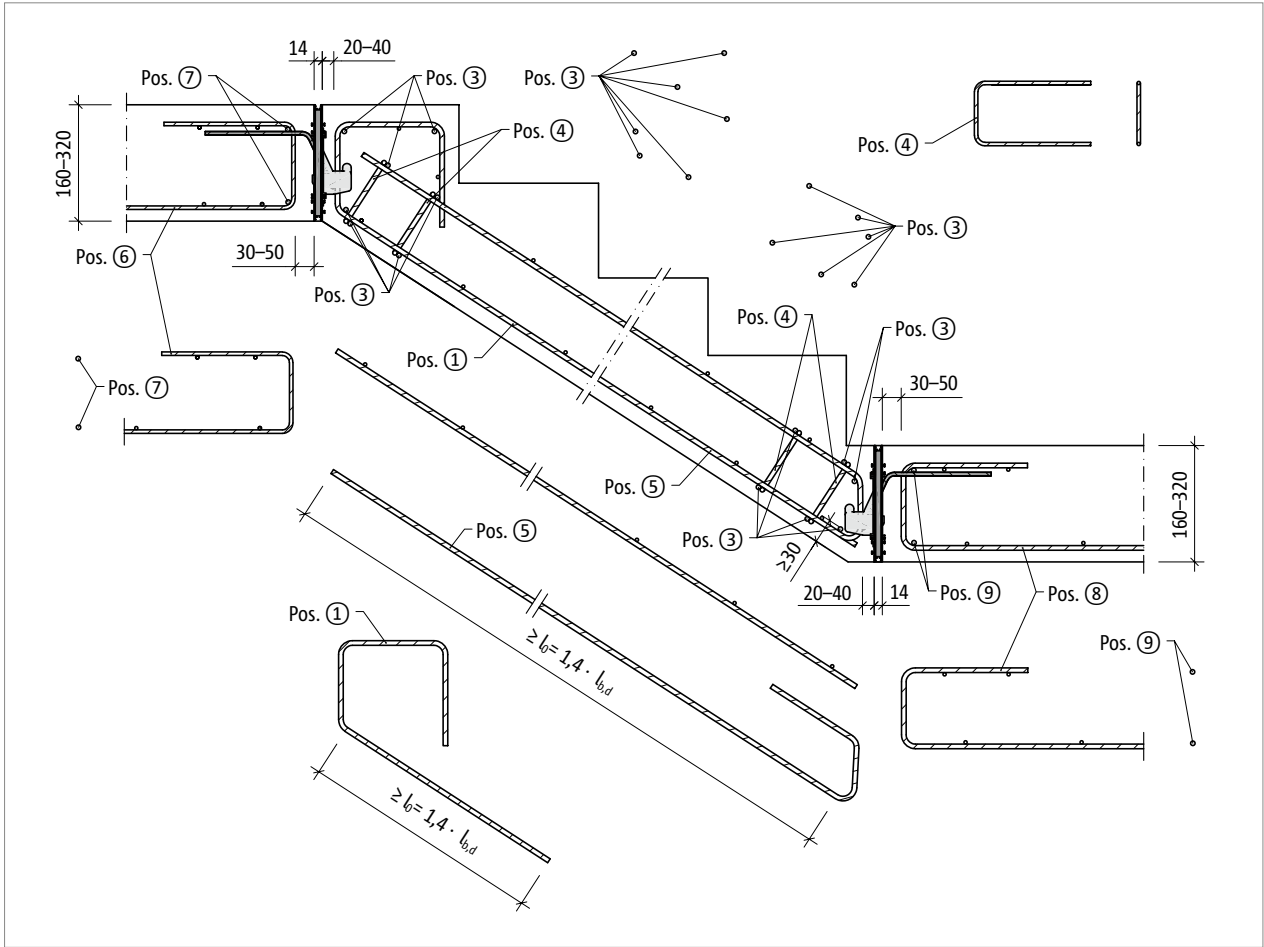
Schöck Tronsole® Typ T: Bauseitige Bewehrung
